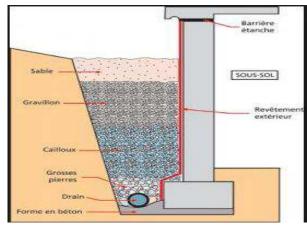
photo d'un mur de soutènement Source : les auteurs.
